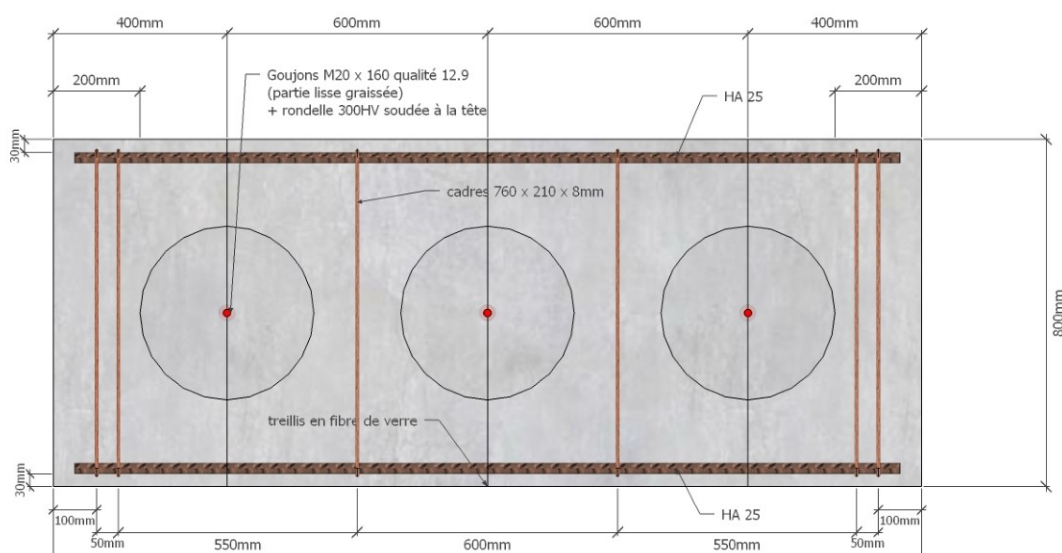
Dimension de la dalle étudiée : Plan.
